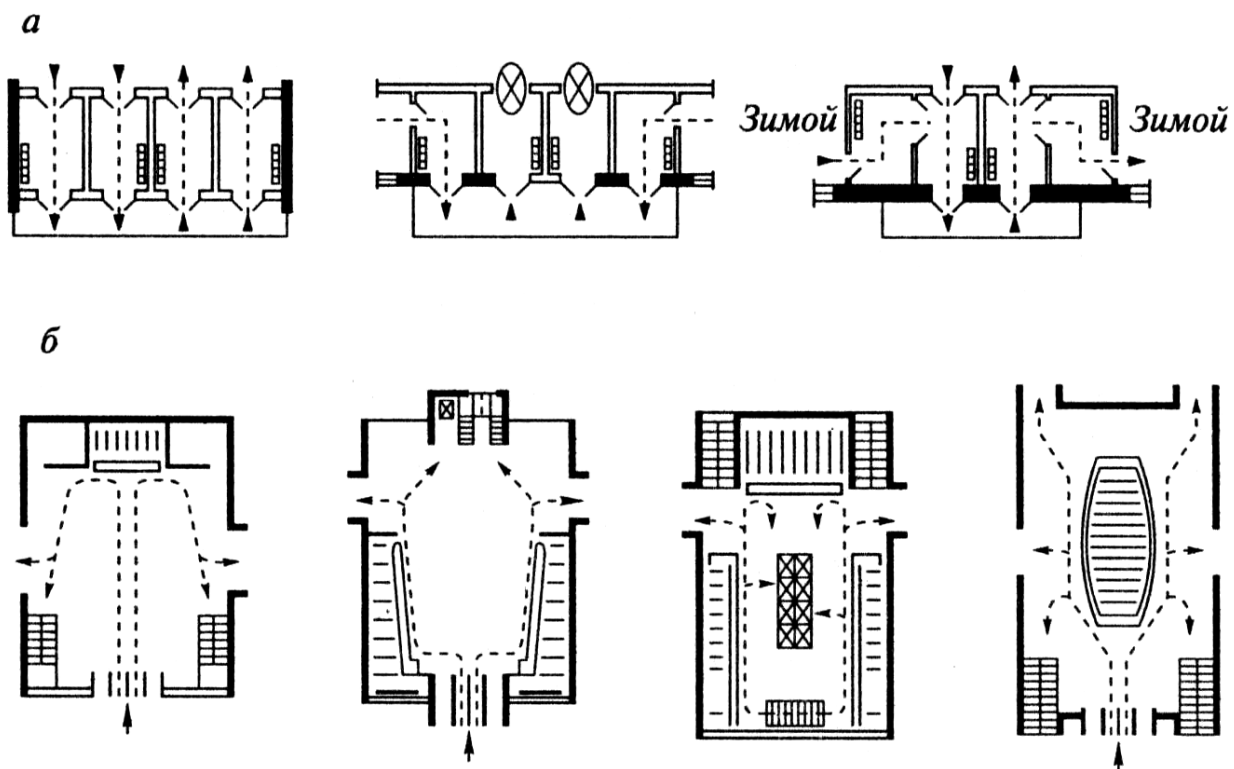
Планувальне рішення вхідної групи в громадську будівлю:
